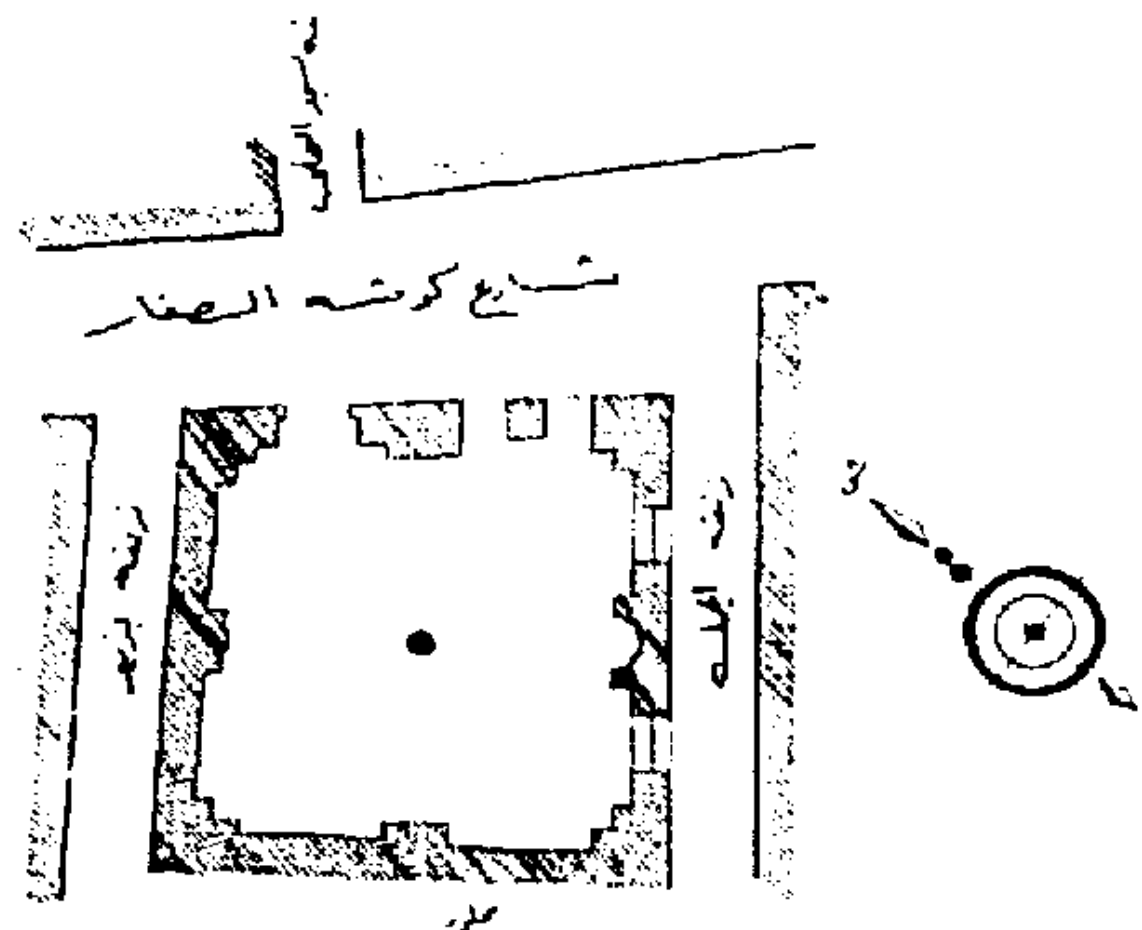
مسقط أفقي لجامع الدباغ عن الموسوعة (الجزء الأول).
